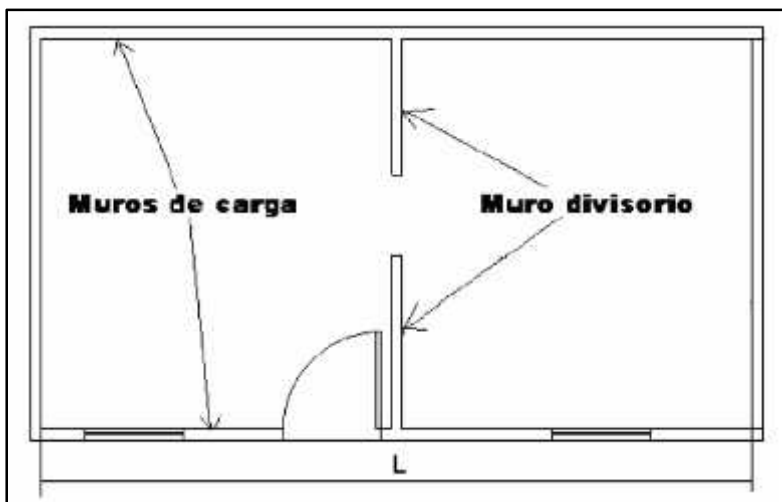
Configuración de los muros en planta y su respectiva separación
